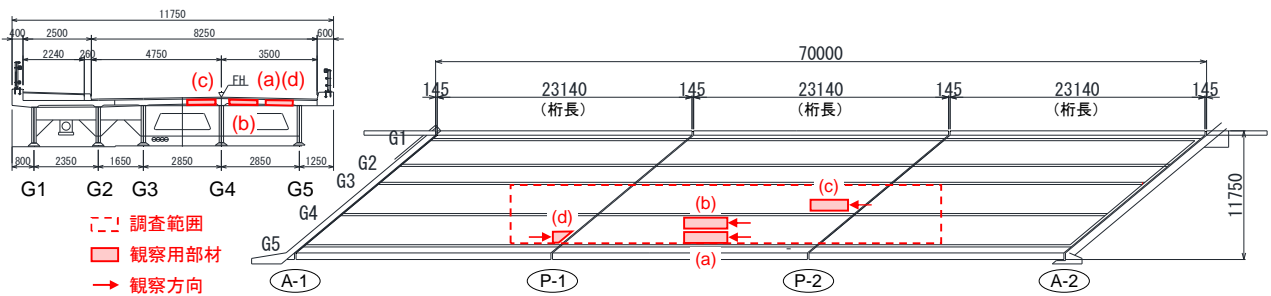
対象橋梁の平面図および断面図ならびに切断面の観察位置
